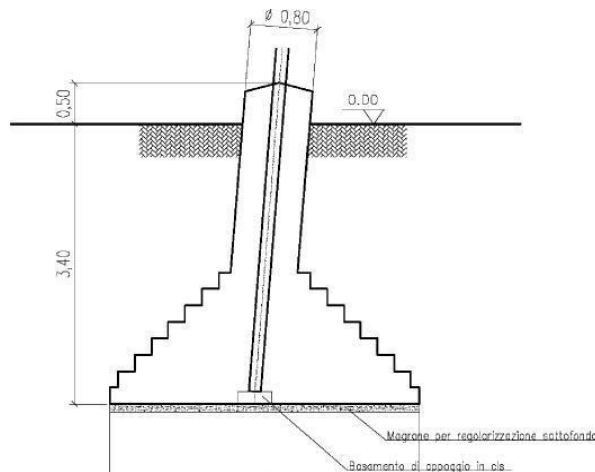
Disegno di progetto per la realizzazione di una fondazione a plinto con riseghe
